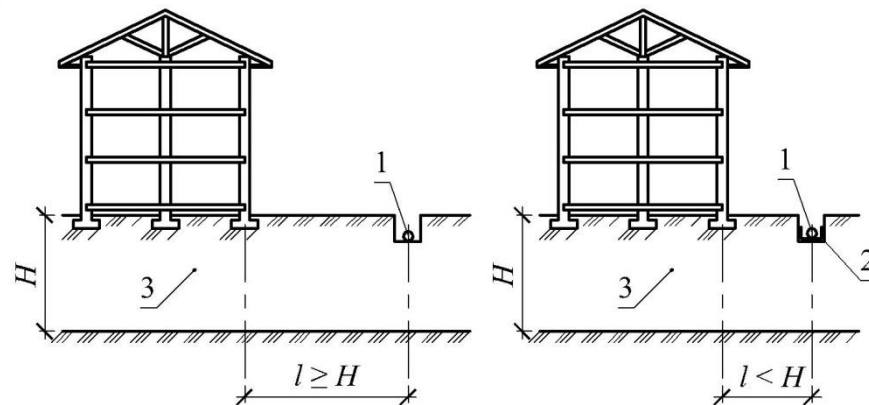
Схема прокладки наружных водопроводных сетей в лессовых просадочных грунтах: а – в траншеях; б – в герметичных лотках; 1 – водопроводные сети; 2 – герметичный лоток; 3 – просадочный грунт; H – мощность просадочной толщи
